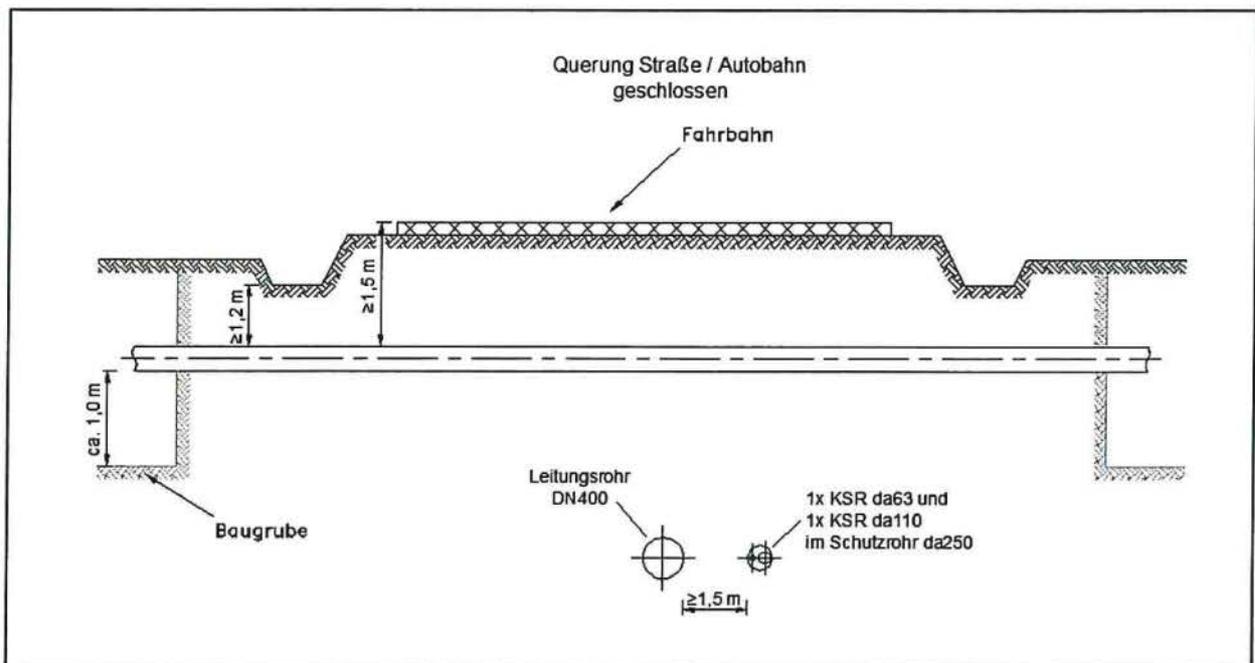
Typenplan Straßenquerung in geschlossener Bauweise
